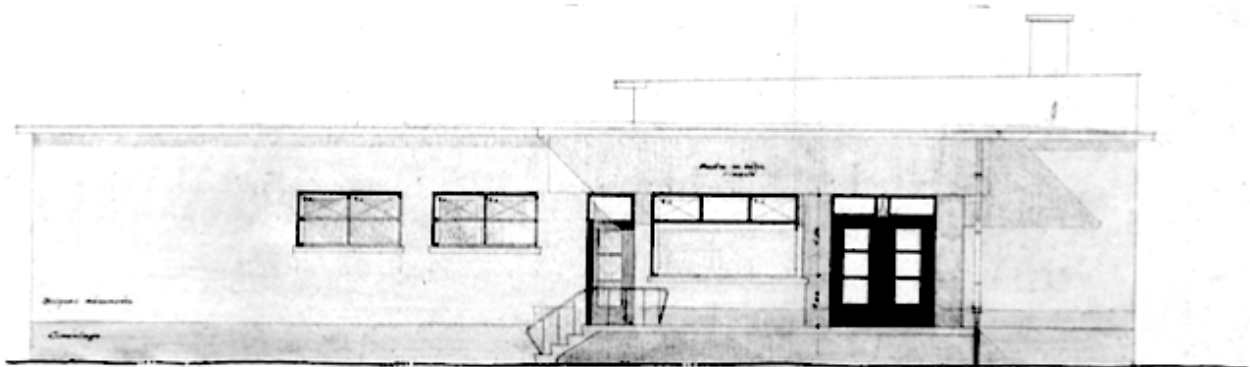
Façade Est (entrée du bâtiment) (Source : Archives de Liège)
